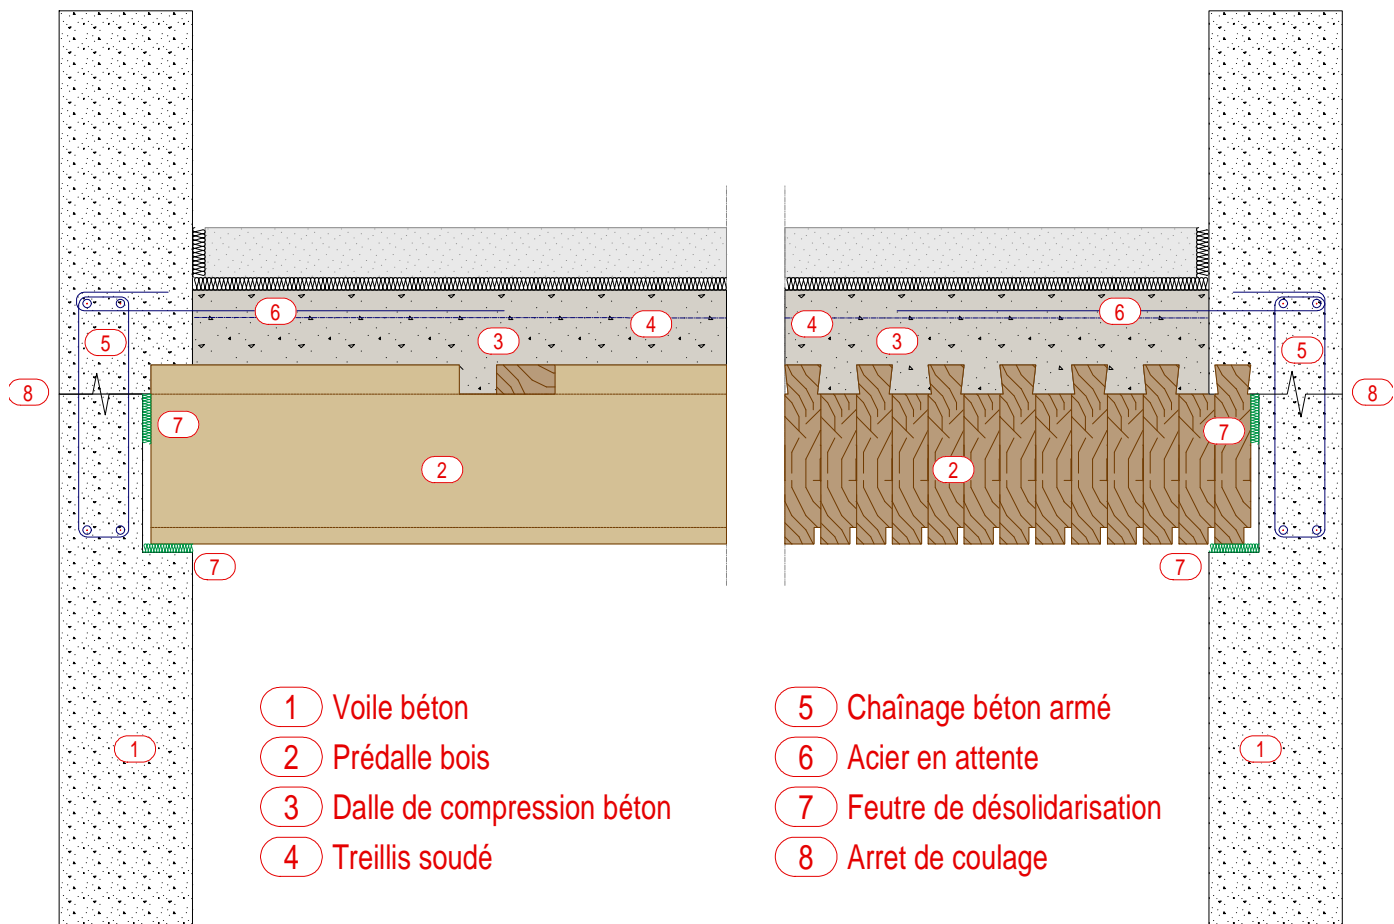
Chaînage du plancher LIGNADAL sur mur béton en zone sismique
